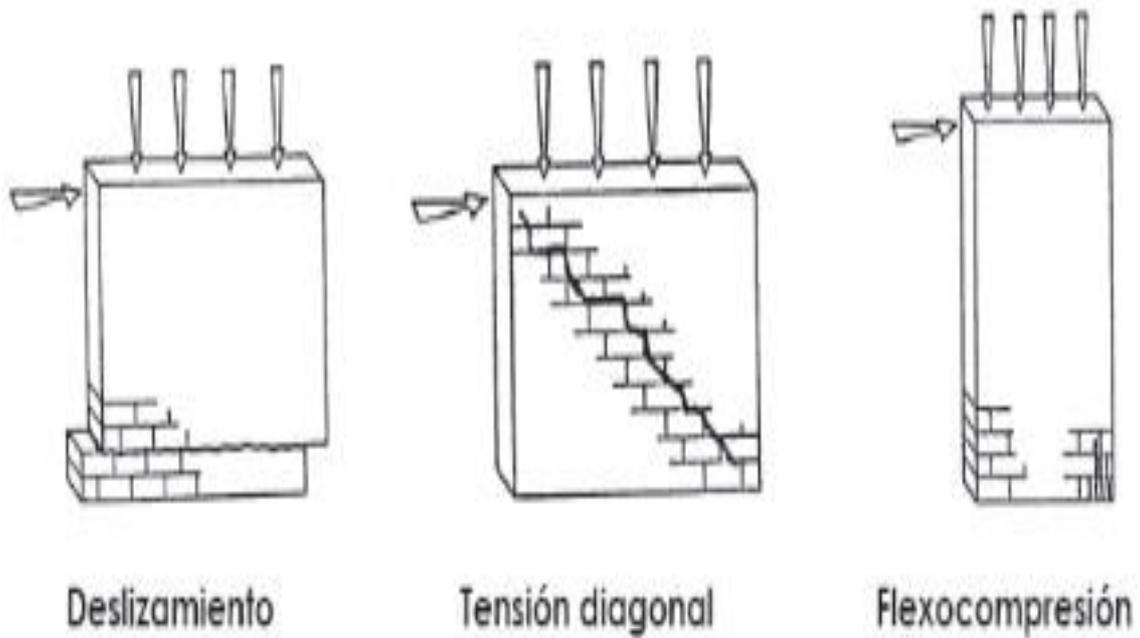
Tipos de falla en los muros de albañilería. Fuente: Youtube.
